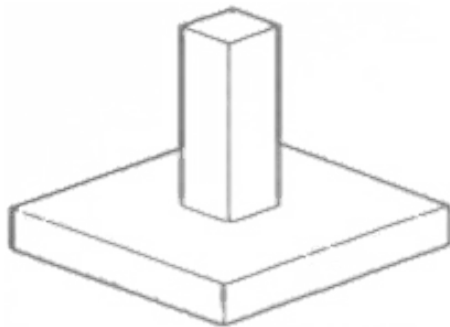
Zapata aislada de forma cuadrada. , <https://supervisiodeestructurasdeconcreto.wordpress.com/2013/03/12/03-cimentacion-superficial-2-3-1-zapatas-aisladas-y-corridas/Octubre2015>
